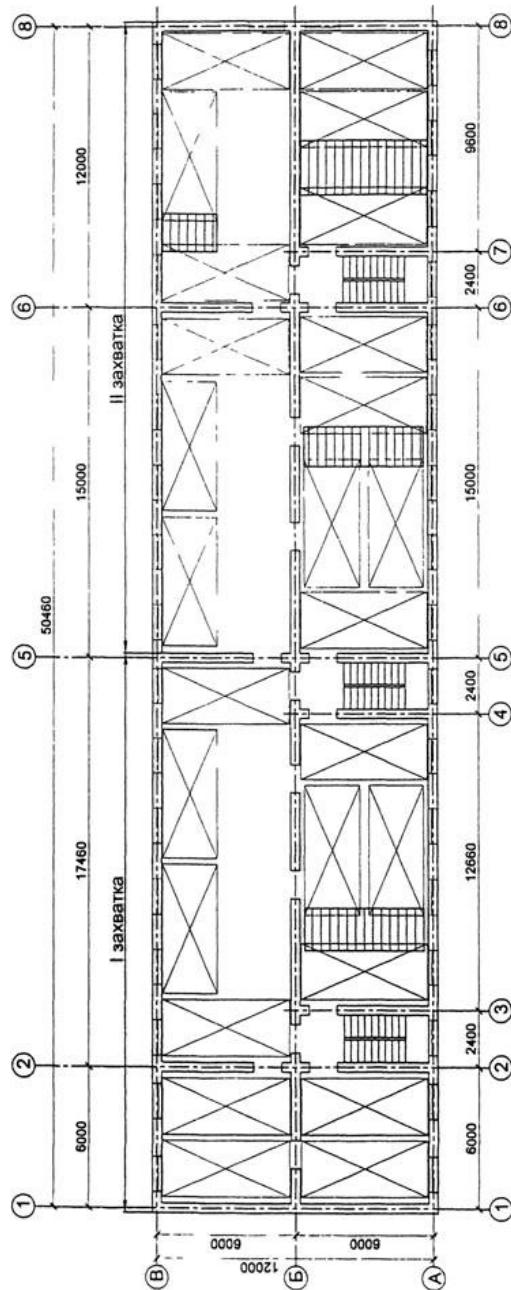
Схема ленточного расположения подмостей с применением навесных площадок для кладки стен лестничной клетки (ГТК на каменные работы «Кирличная кладка наружных стен»)
